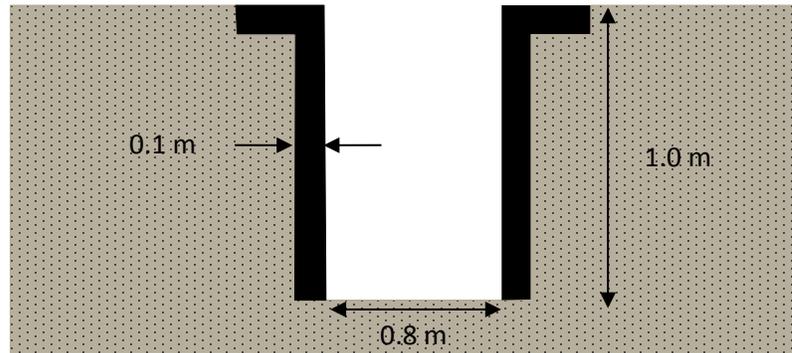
Esquema de excavación de zanja para pantalla impermeable
